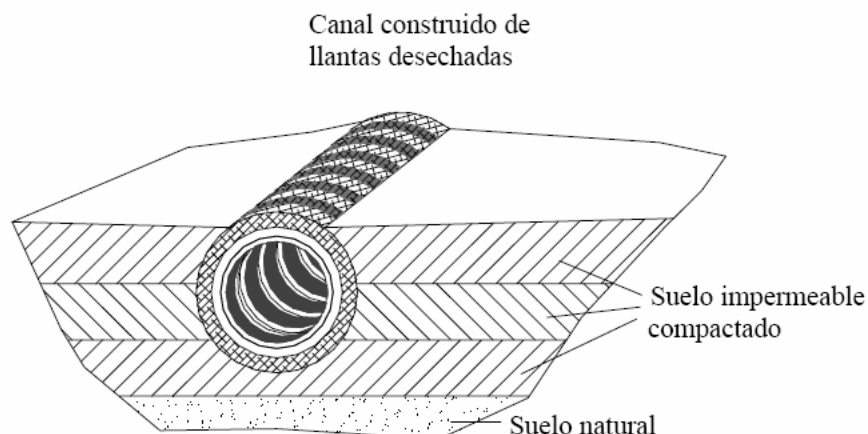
Canal de drenaje construido con neumáticos en desuso.
